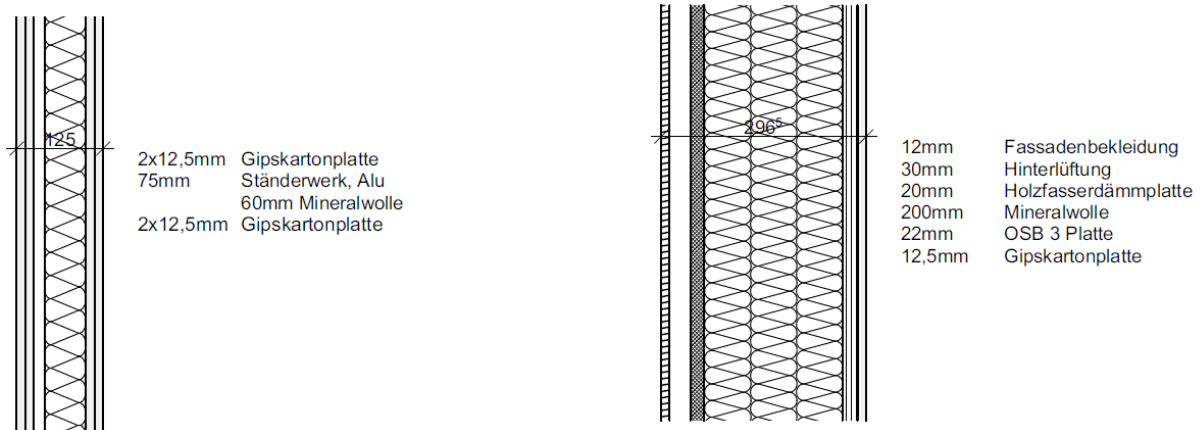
Wandaufbau und Fassadenaufbau Standartraum
